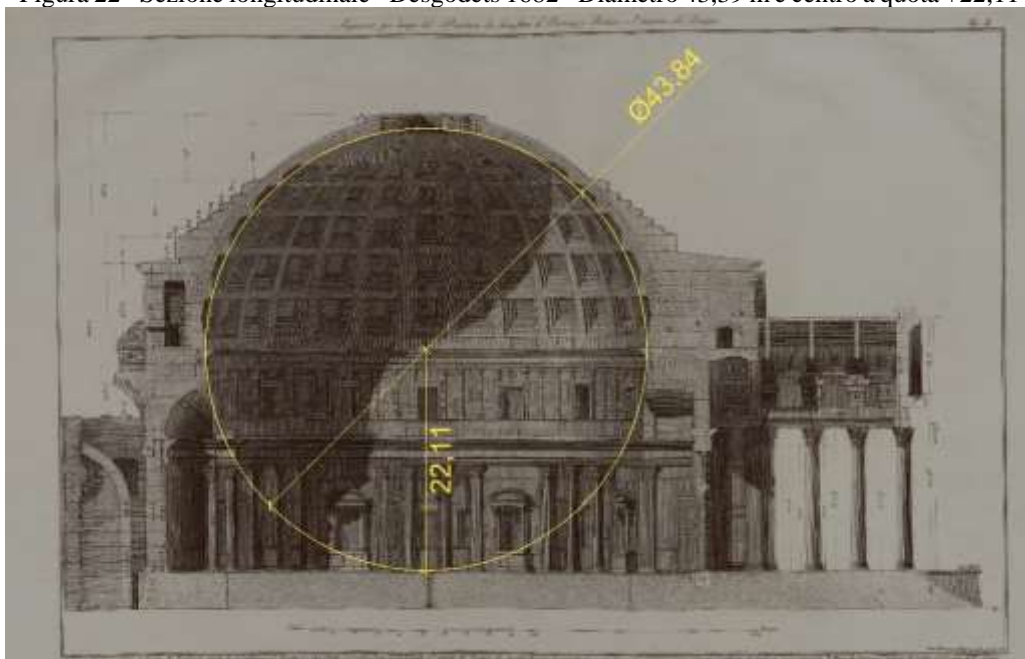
Sezione longitudinale - Pianesi 1756 - Diametro 43,84 m e centro a quota +22,11
